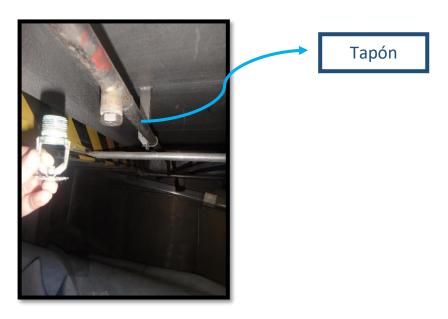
Taponamiento de un drencher. Fuente: Trabajo de campo.
